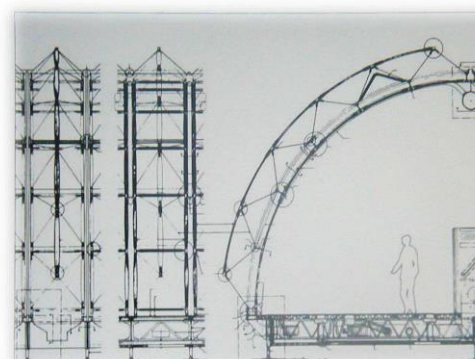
Detalhe do projeto Pavilhão da IBM.
